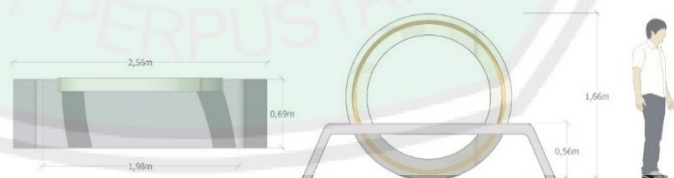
Ilustrasi bangunan kecil pada zona adventure
